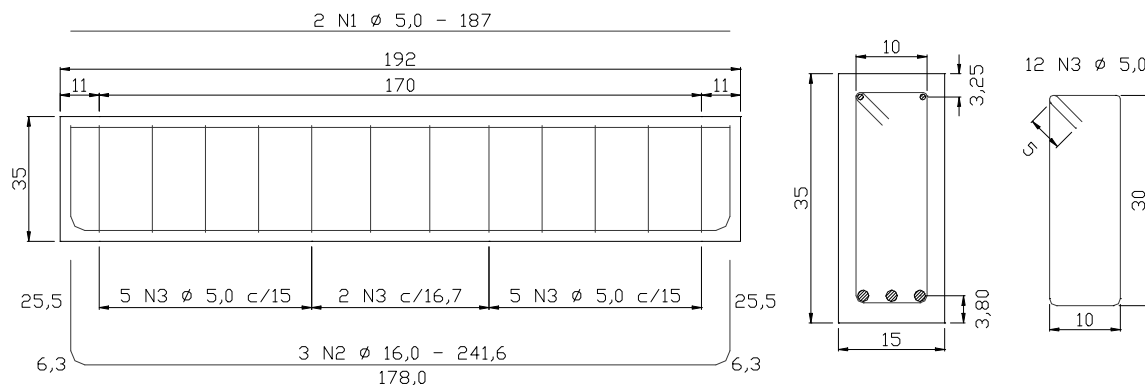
Detalhamento das armaduras das vigas do grupo VC (cotas em cm)
